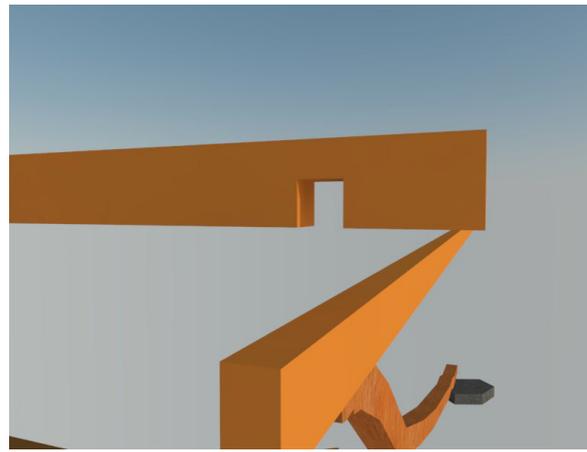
Struktur Bangunan Ehome (Fondasi) Omo Sebua
